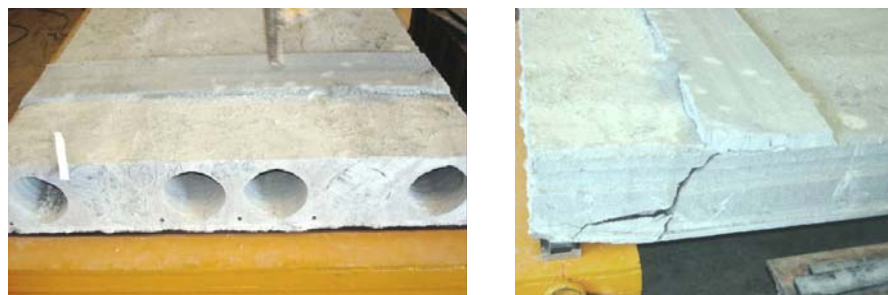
Configuração de fissuração das lajes com dois alvéolos preenchidos.
